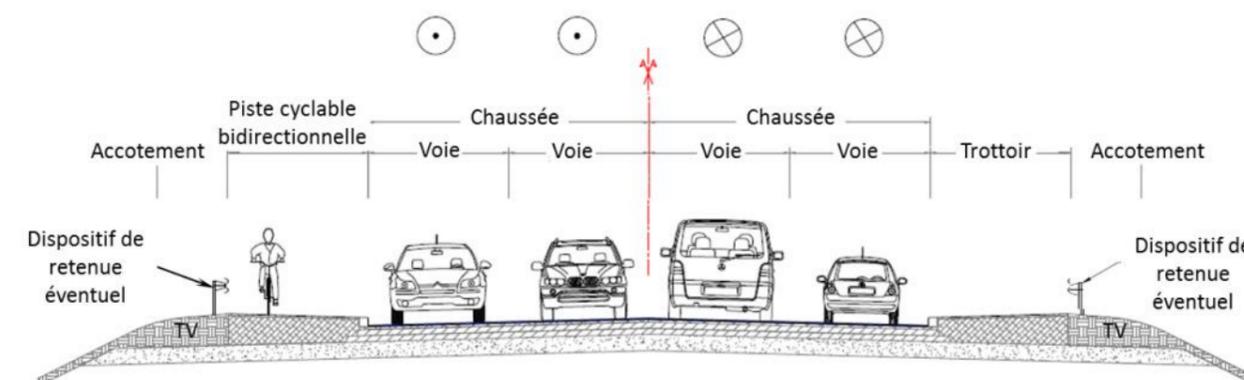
Profil en travers type de la RD 128 au droit de l'ouvrage de franchissement.
